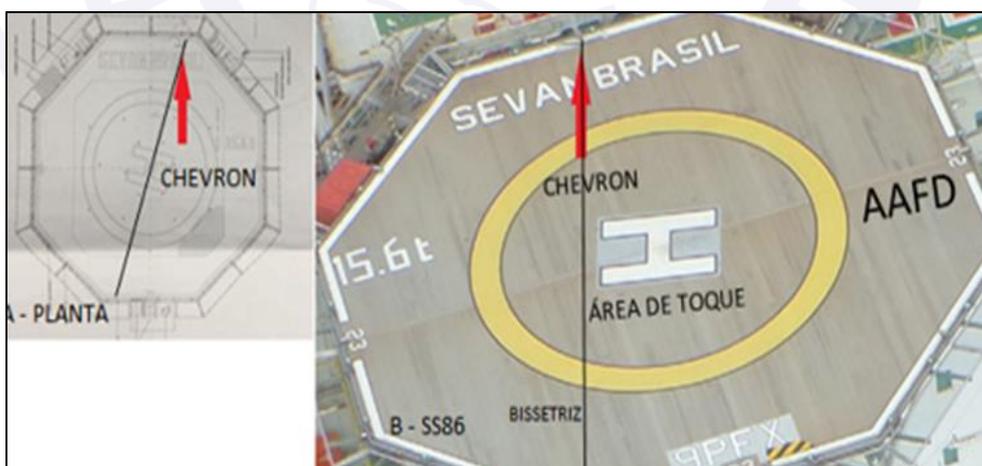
A e B - Localização do *chevron* na Planta e na SS-86.
